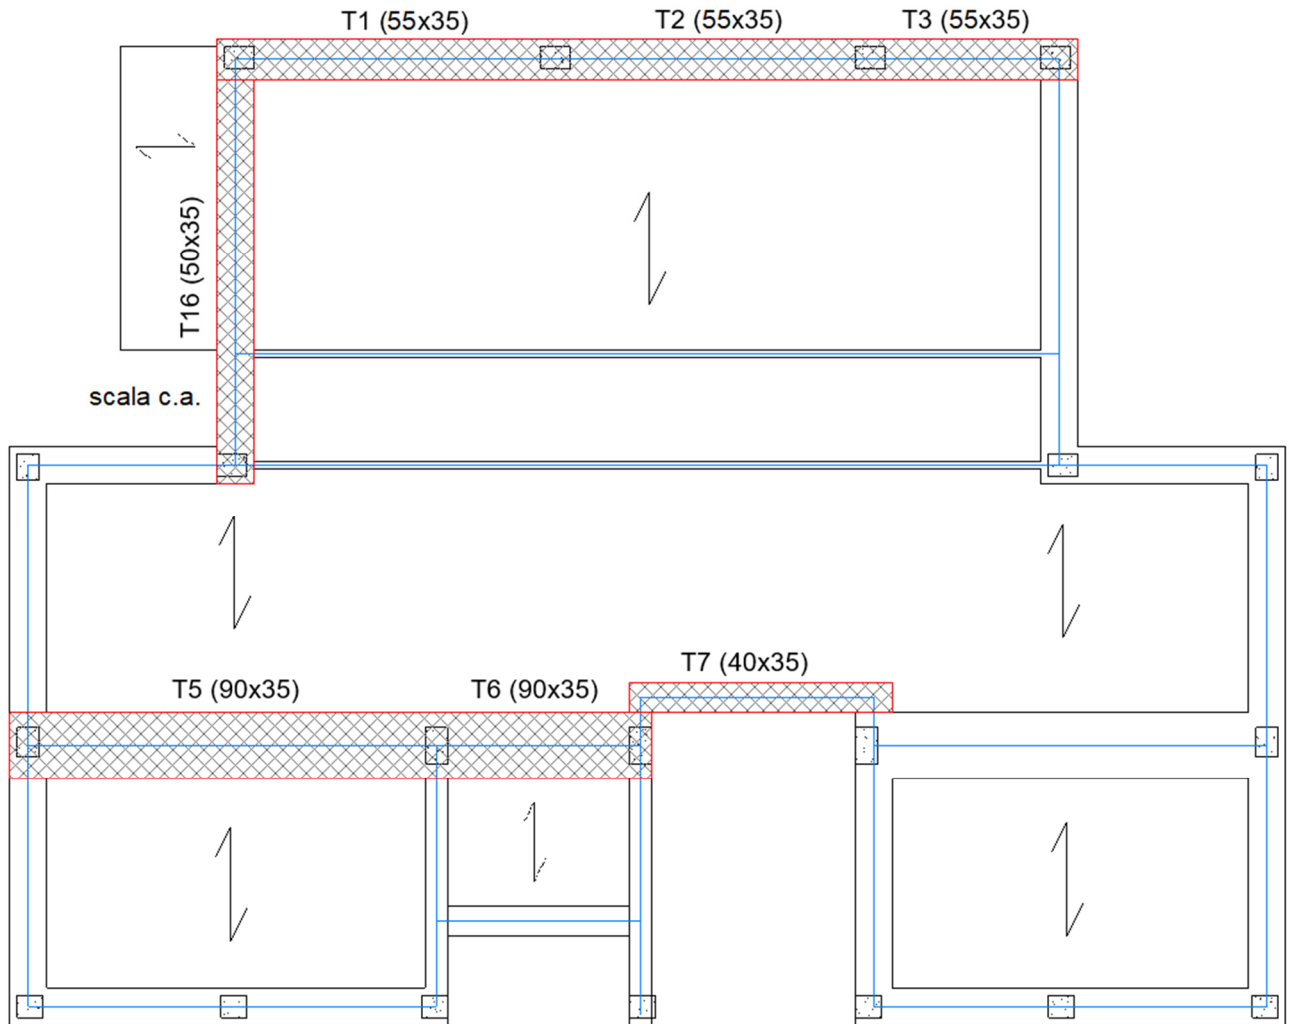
travi oggetto di verifica (carpenteria piano rialzato)
